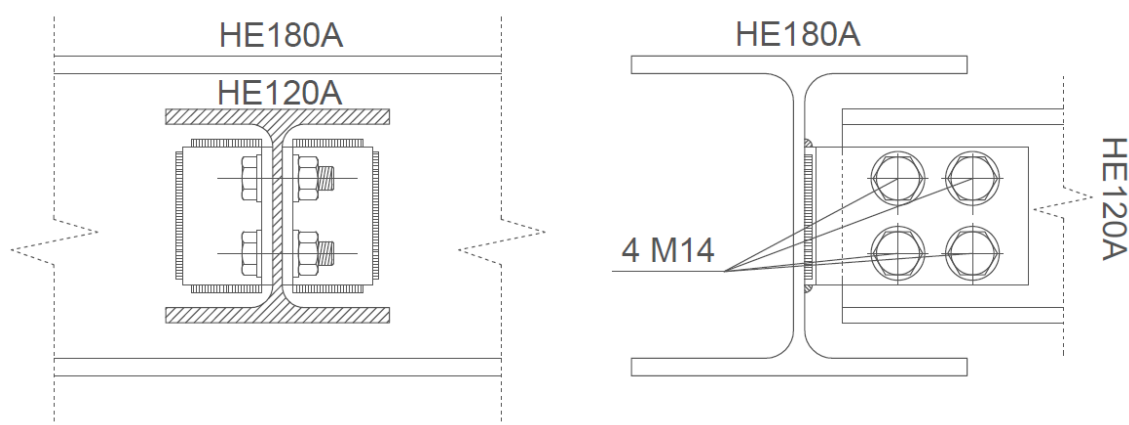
Collegamento trave secondaria-traverso passerella
